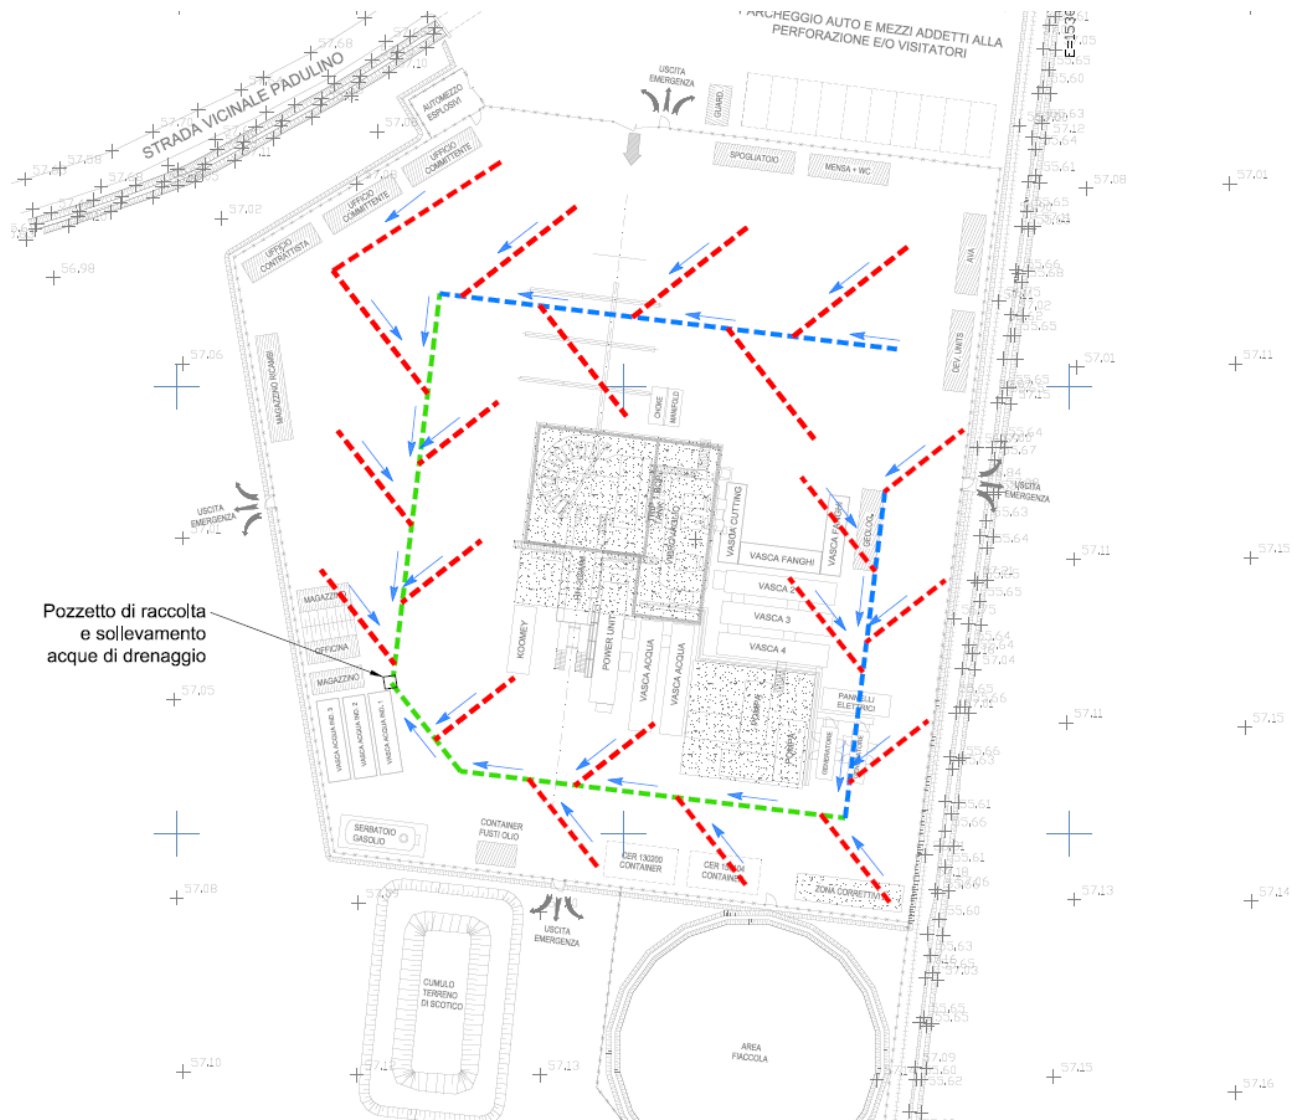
del presente documento - Layout schematico rete drenaggi all'interno del piazzale, Elaborato di Progetto "PDBELLA014"
